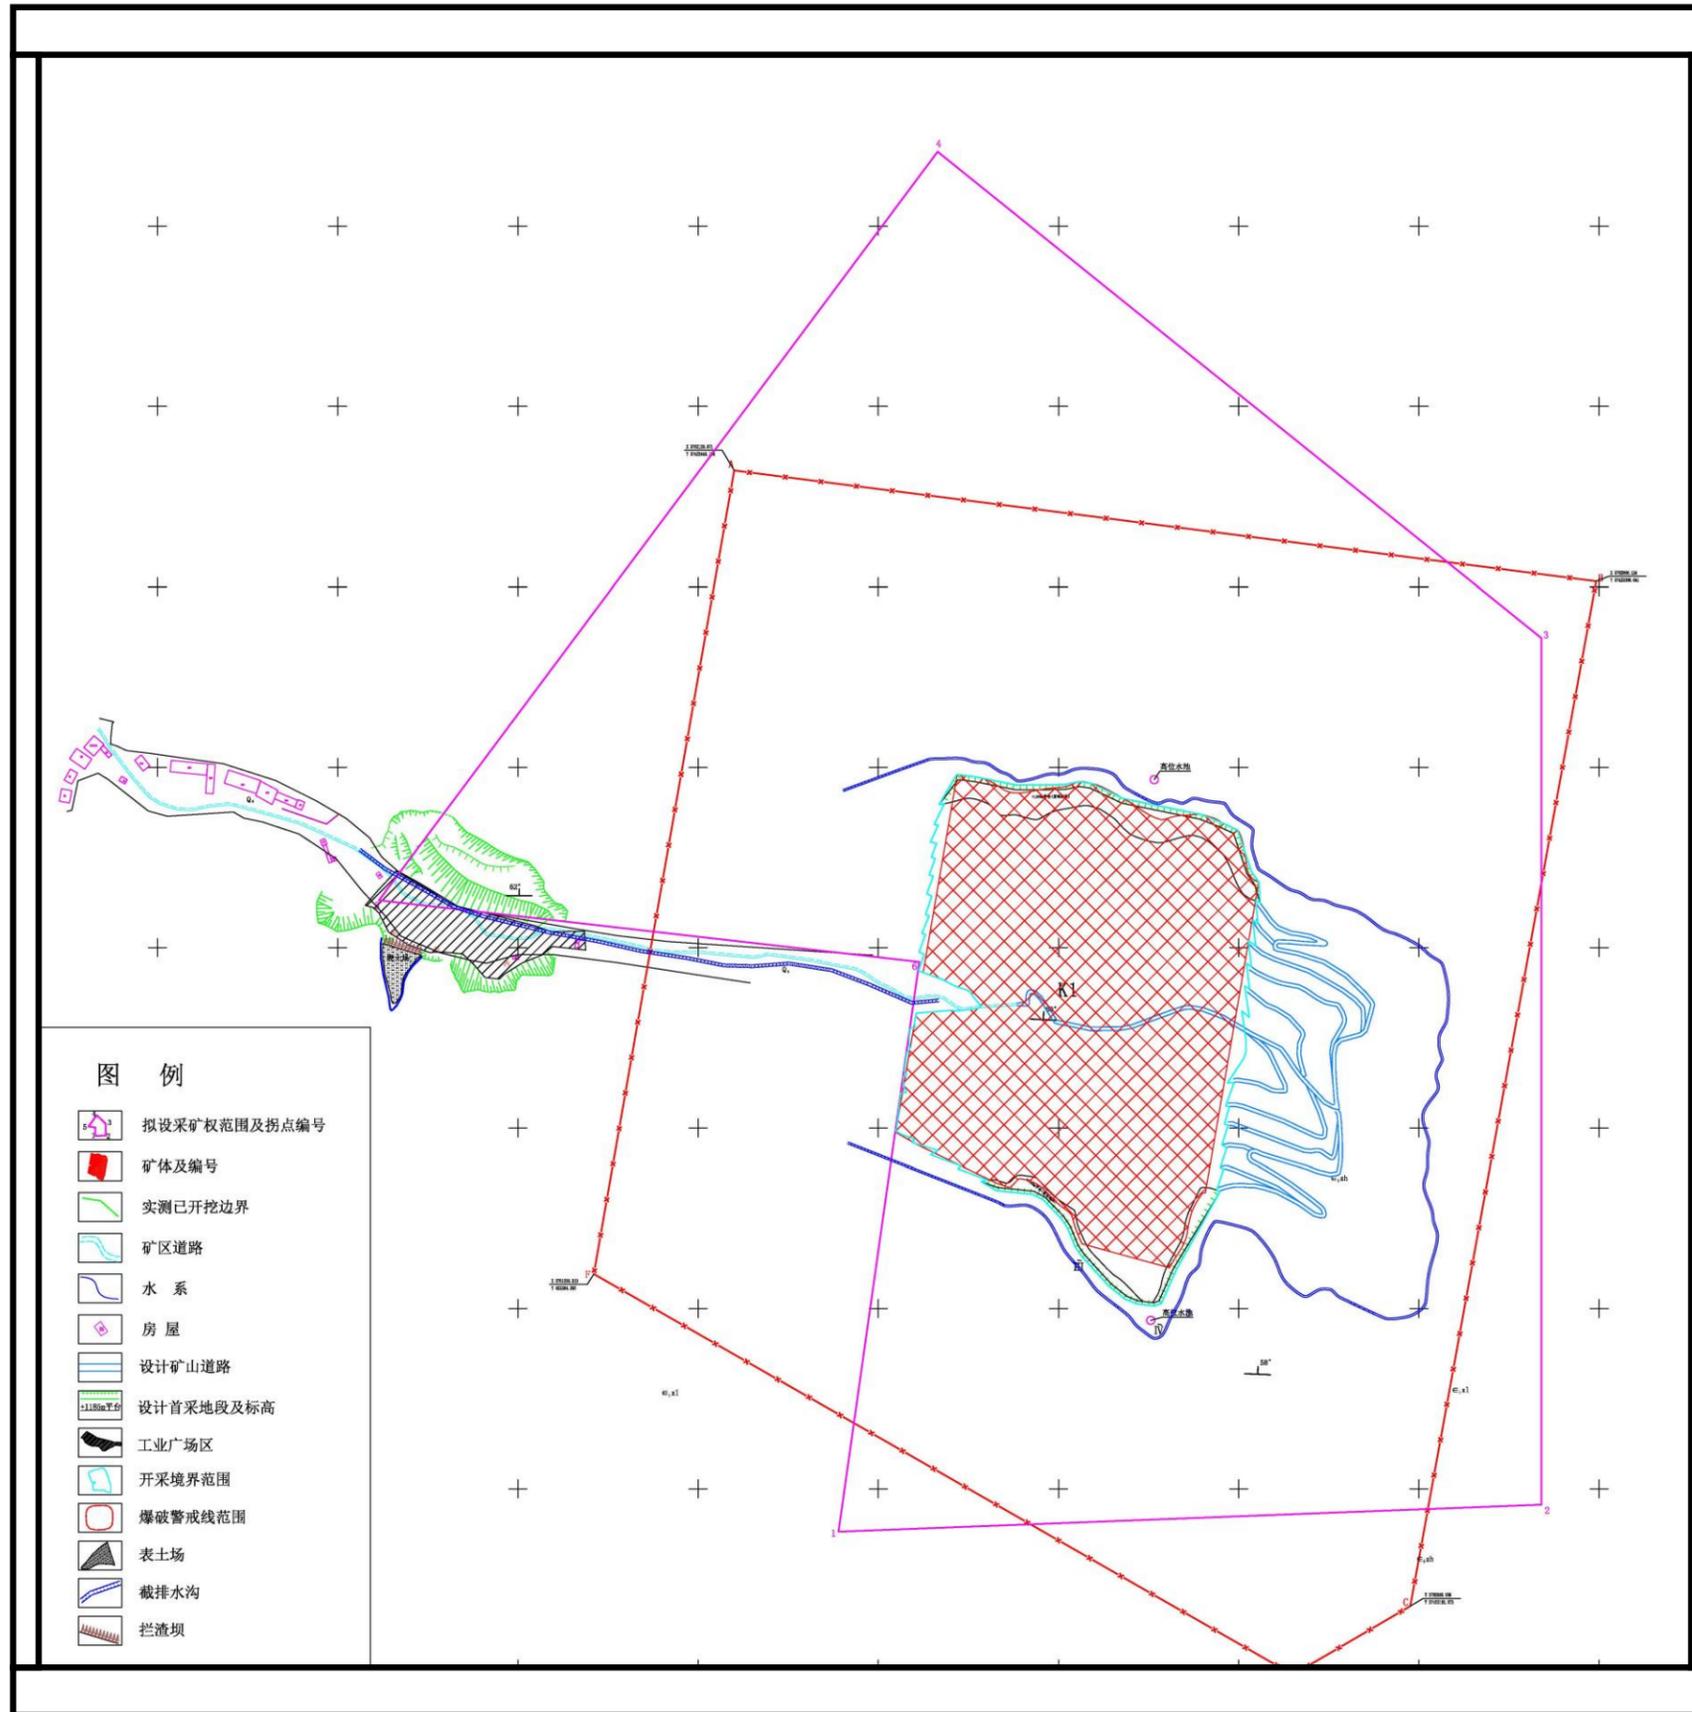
矿区总平面布置图 (比例尺 1 : 10000)
